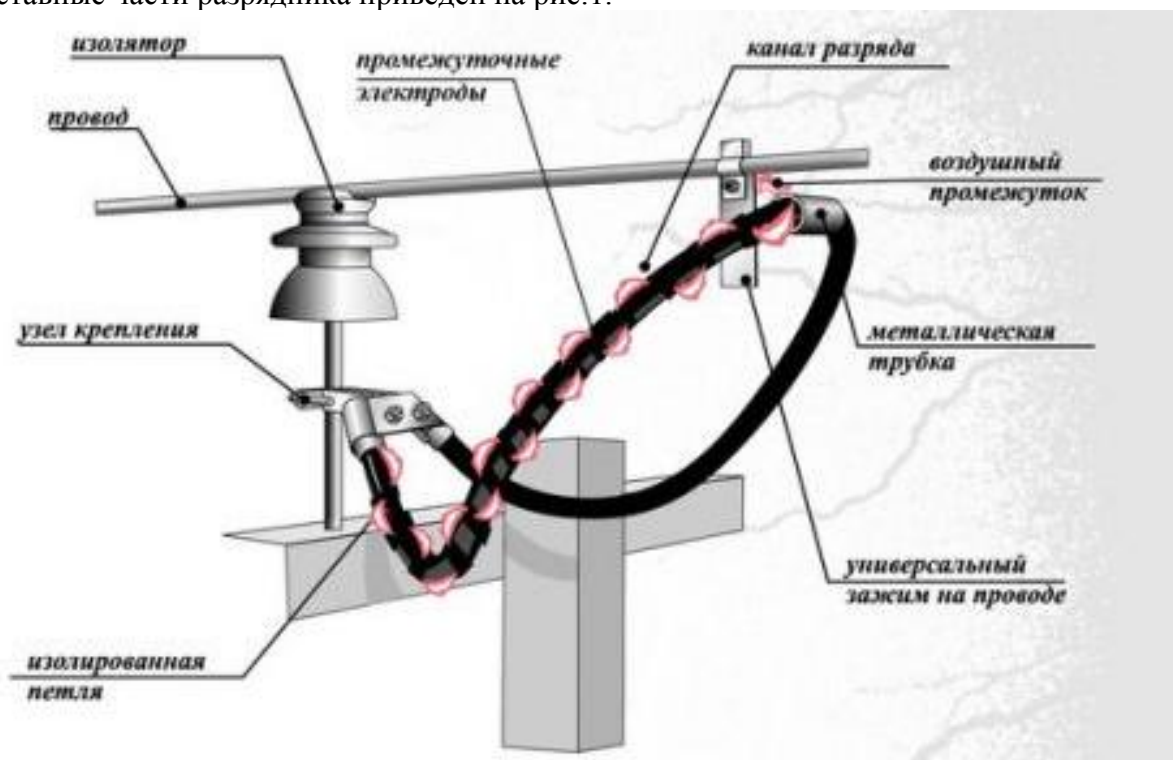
Конструктивный эскиз РДИП-10-IV-УХЛ1
